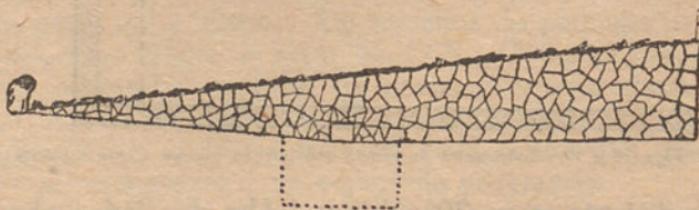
Estrumeira de rampa, em dois planos—Corte
